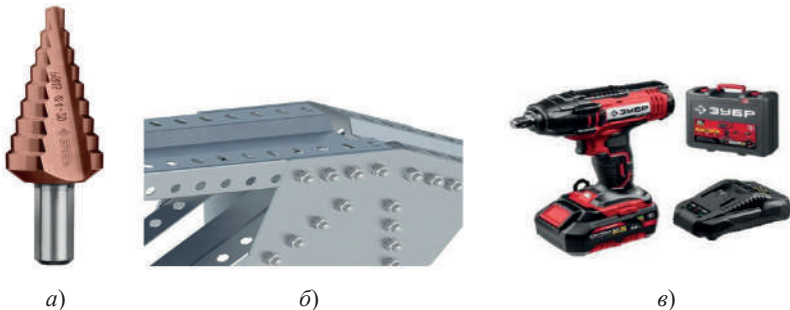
Болтовое соединение и инструмент для сборки каркаса:
